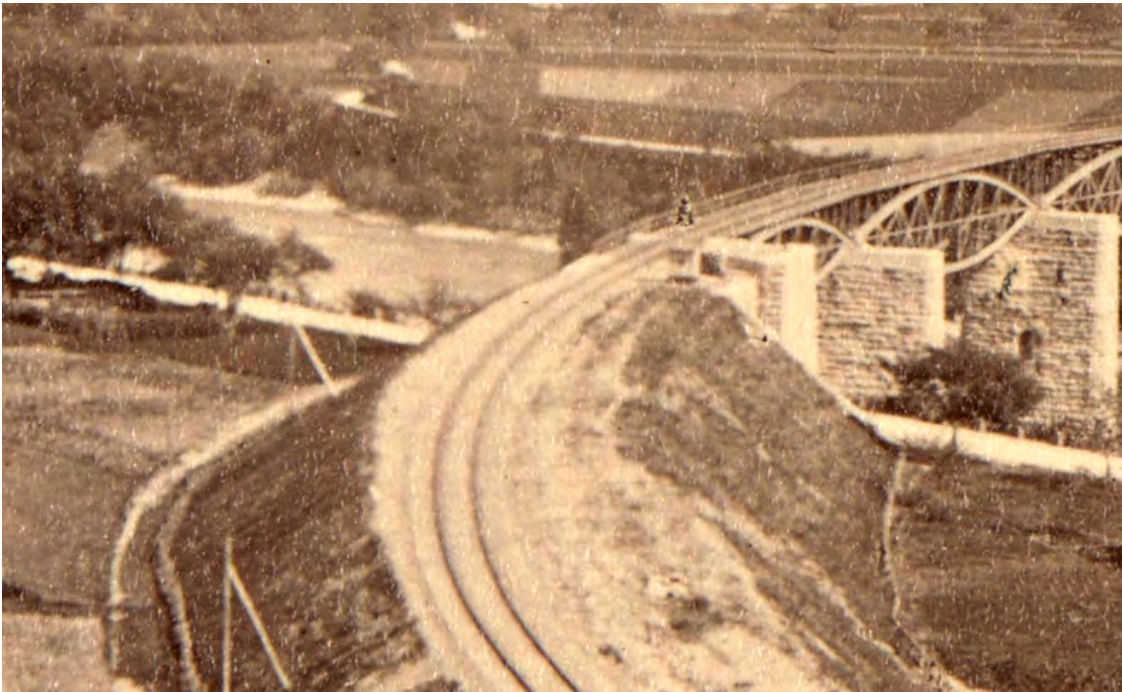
(en haut) : Pont de Brugg sur l'Aar en chantier (coord. : 47.48322N, 8.19613E), ligne du Bözberg, construit en 1874-1875 par Beat Gubser (ETHZ Bibliothek). Les poutres lenticulaires sont de type « Pauli ». Les piles du pont de Brugg sur l'Aar sont construites pour une future seconde voie.
